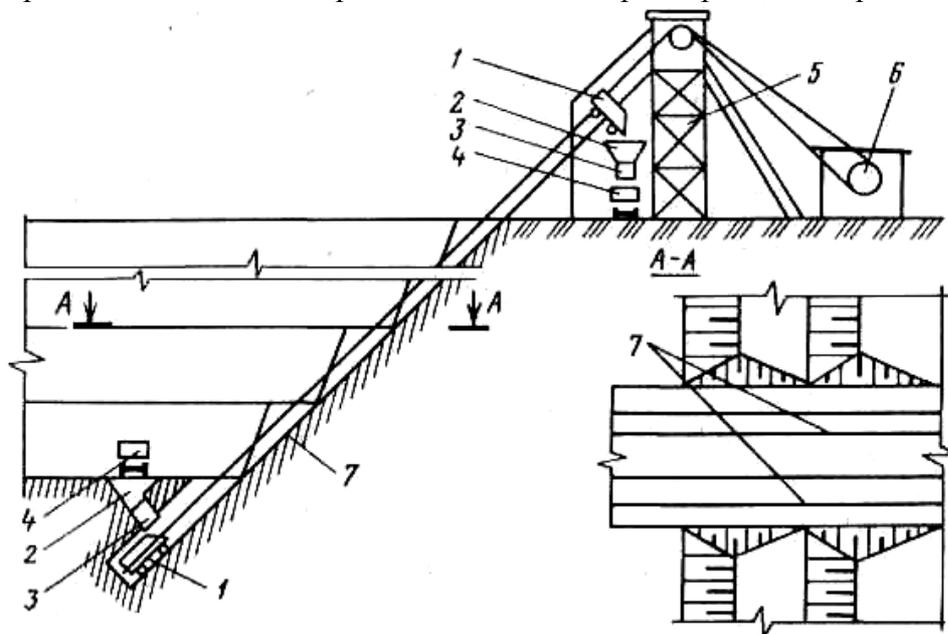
Схема скипового наклонного подъемника: 1 – скипы; 2 – бункер; 3 – дозатор; 4 – вагон (автосамосвал); 5 – копра; 6 – подъемная установка; 7 – рельсовые пути для скипов
